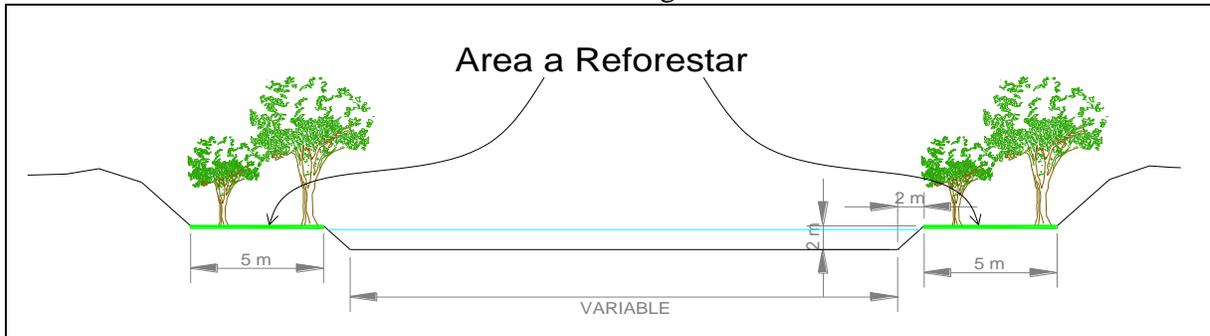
Sección tipo del cauce con el proyecto finalizado.
